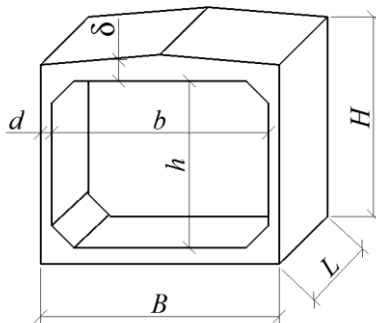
Звено железобетонное прямоугольное водопропускной трубы средней части
